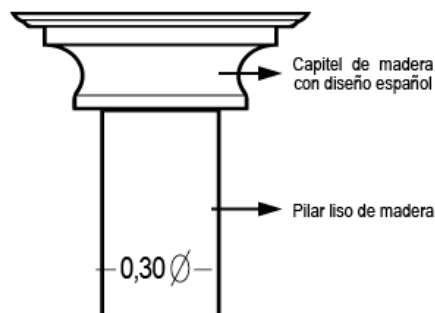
En la ilustración se observa el detalle del capitel que corona el pilar estructural de la galería o pasillo de la vivienda. Este diseño se repite en cada uno de los pilares estructurales de toda la galería posterior de la vivienda.
